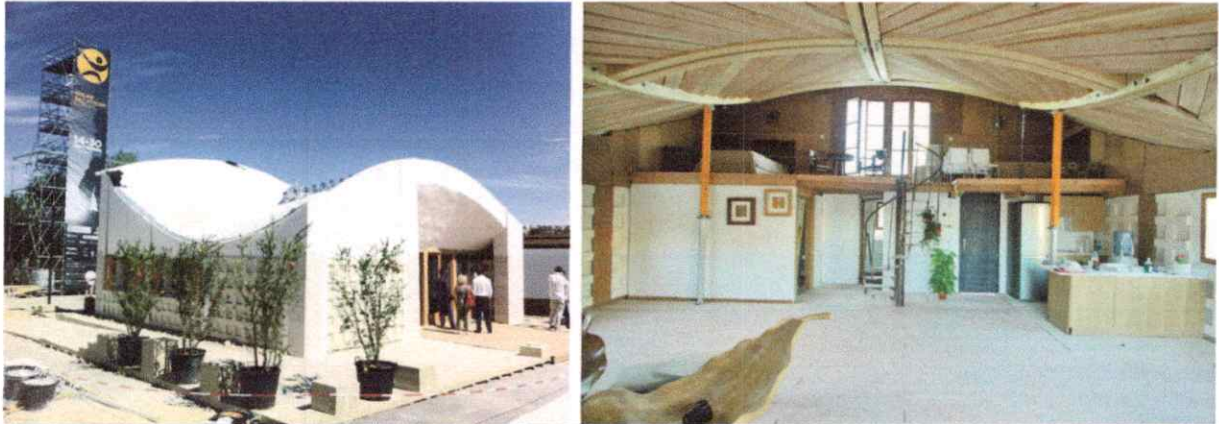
Projet d'Astonyshine, Photo de gauche montre les façades sud et ouest de la maison et de l'image sur la droite les intérieurs, source : Journal of Space Structures
